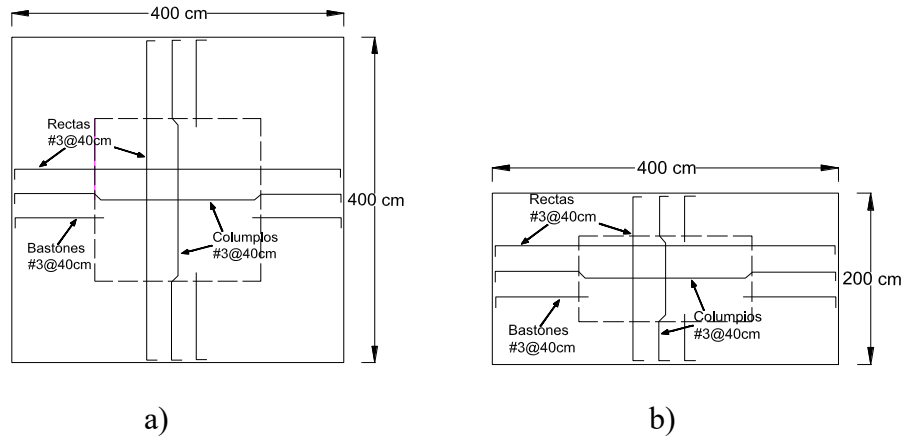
Vista en planta del armado de las losas: a) cuadrada y b) rectangular
